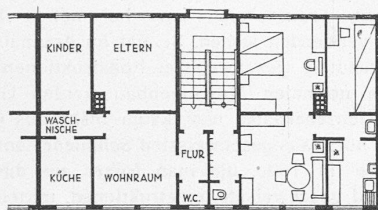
Grundriss des Holzskelett-Baublocks.
